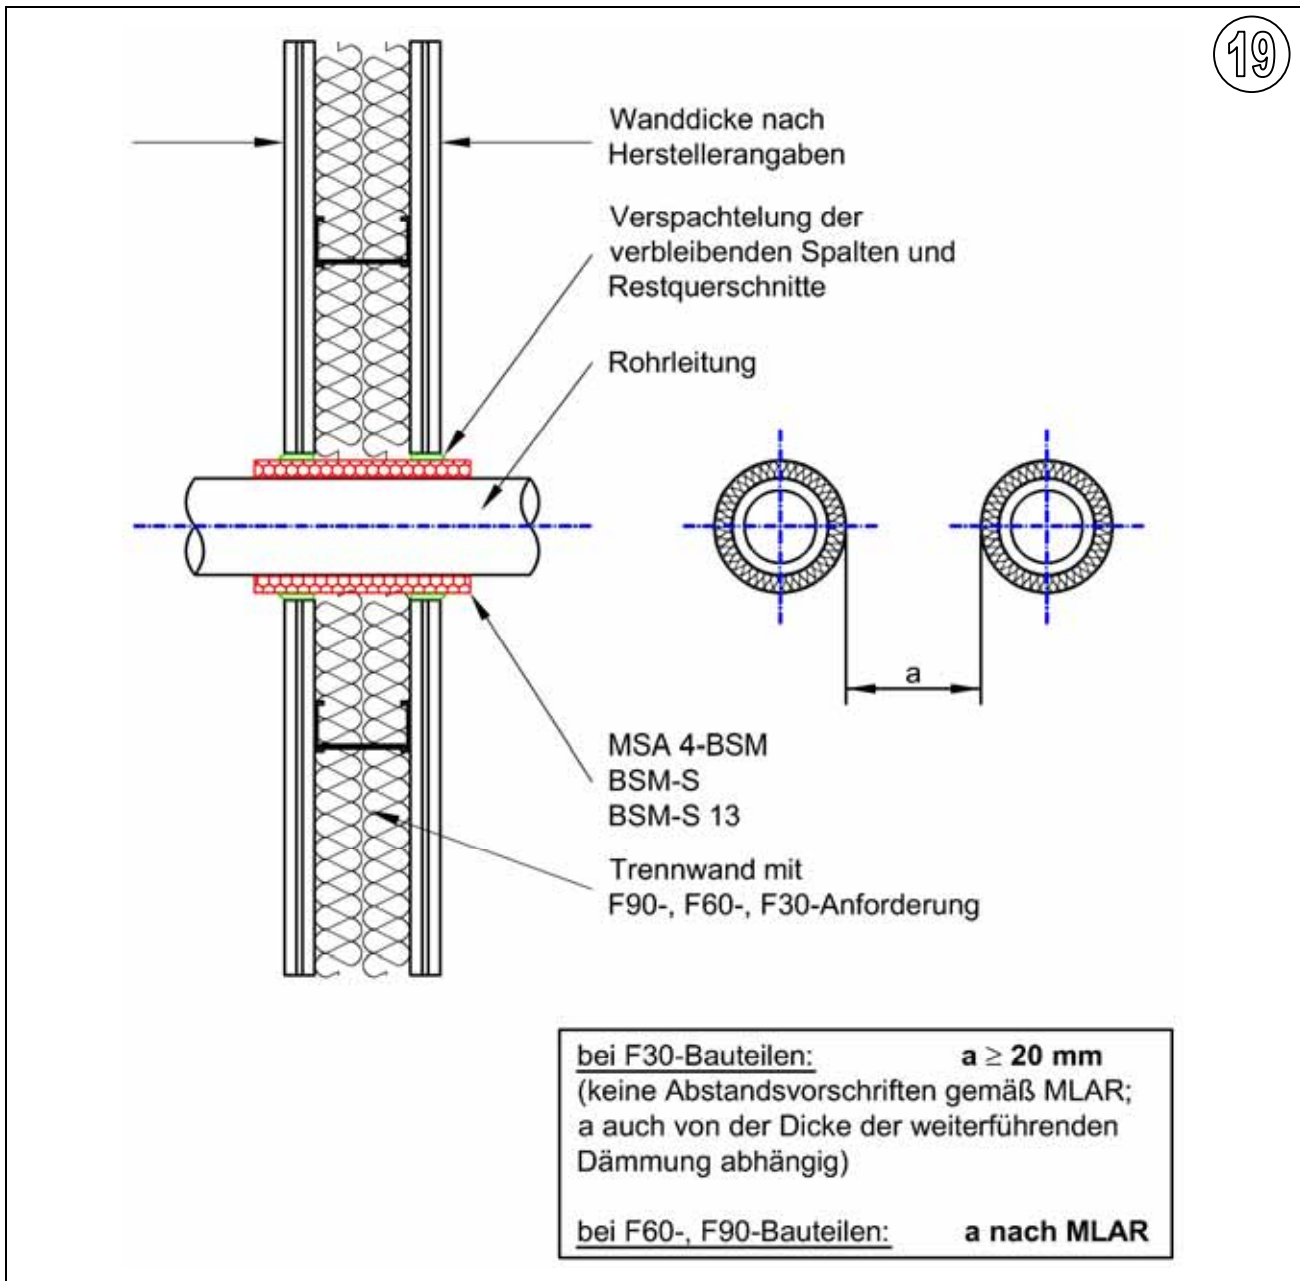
Rohrdurchführungen durch leichte Trennwände (Metallständerwände) mit F90-, F60- und F30-Klassifizierung
